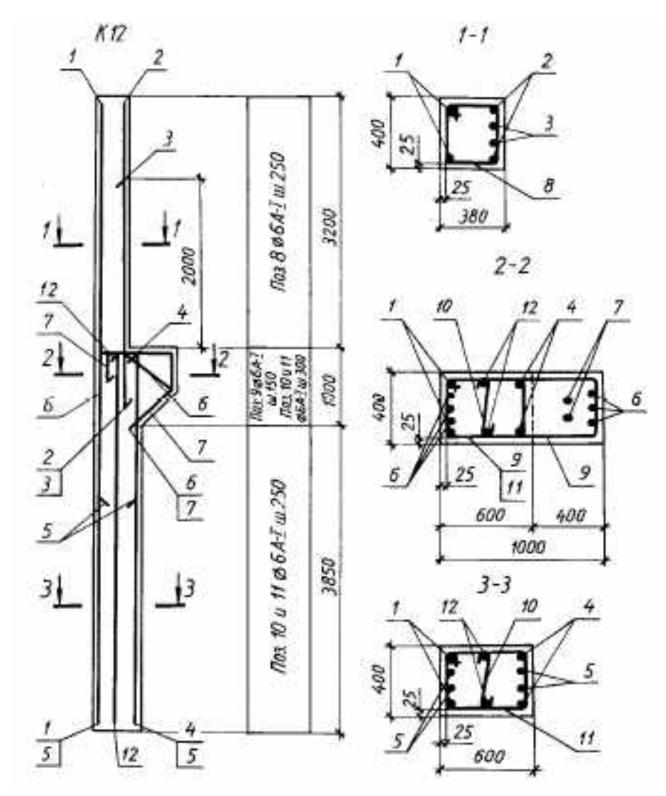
Сборные ж/б колонны (схема армирования)
